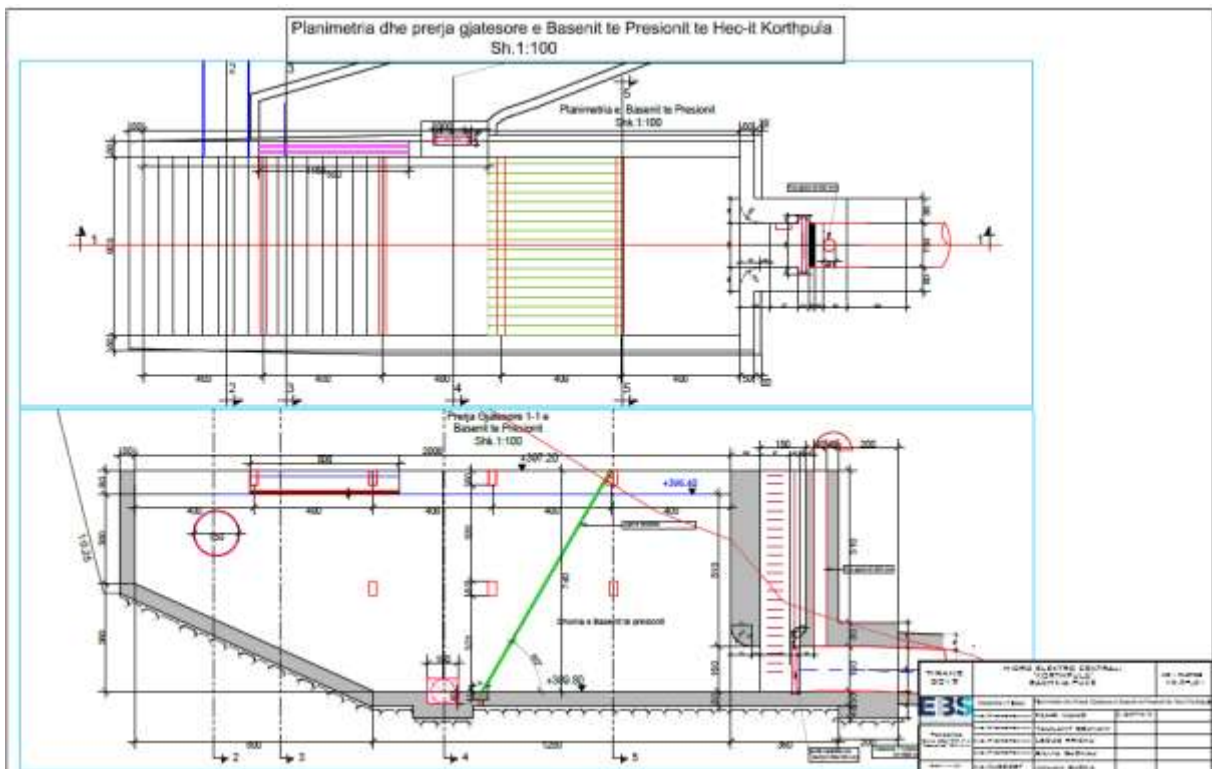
Planimetria dhe prerja gjatesore e Basenit te presioni
